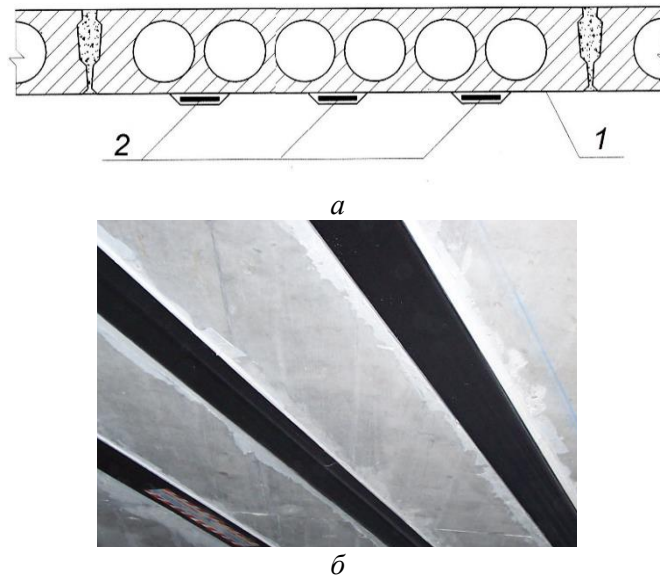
Улаштування стрічок з вуглецевих волокон на нижню поверхню залізобетонного перекриття:
